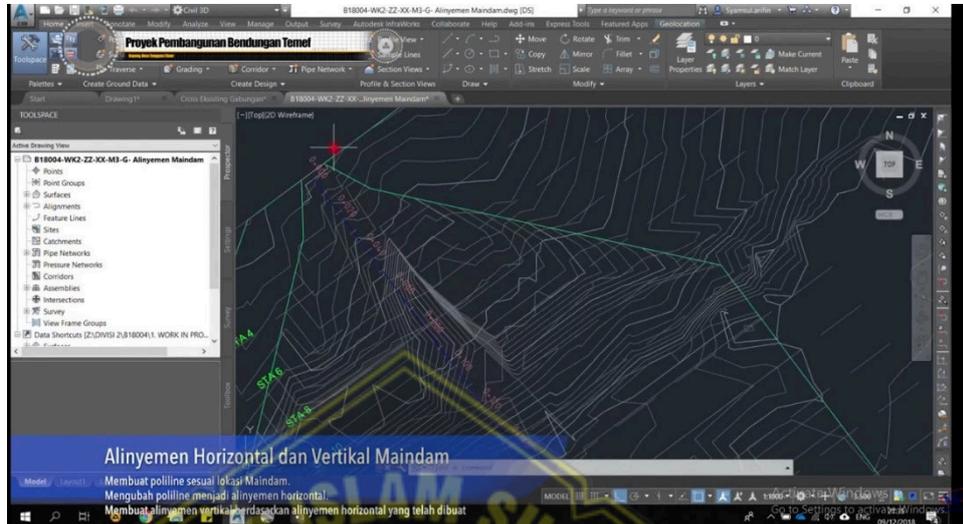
Plotting Existing Ground Bendungan Temef
